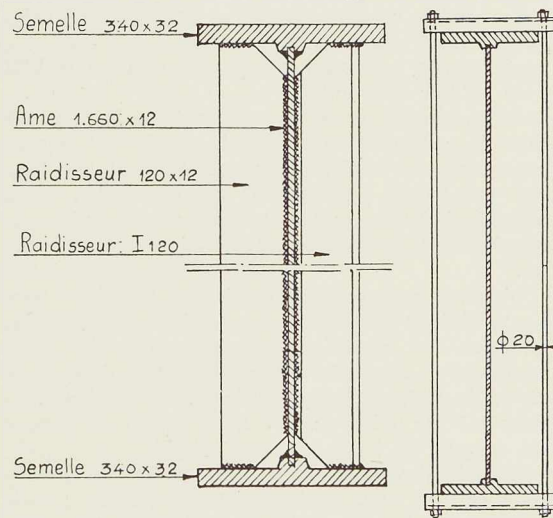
Coupe transversale d'une poutre principale : le croquis de droite montre le dispositif employé pour le maintien des pièces en place au cours de l'assemblage.
